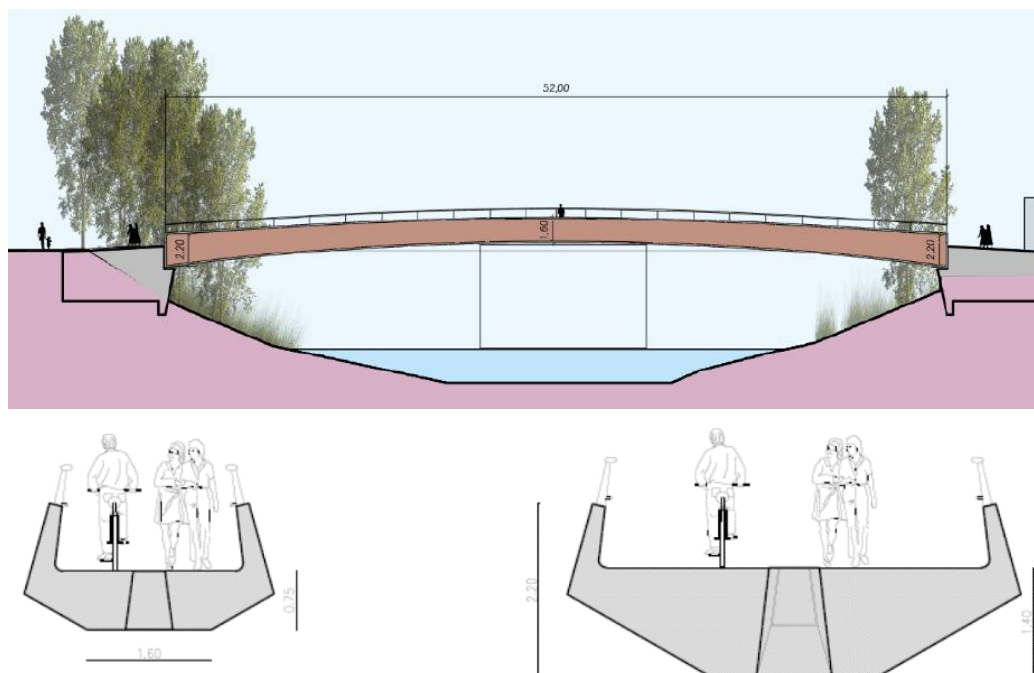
Coupe et profils en travers d'une passerelle non courante avec tablier mono-caisson
